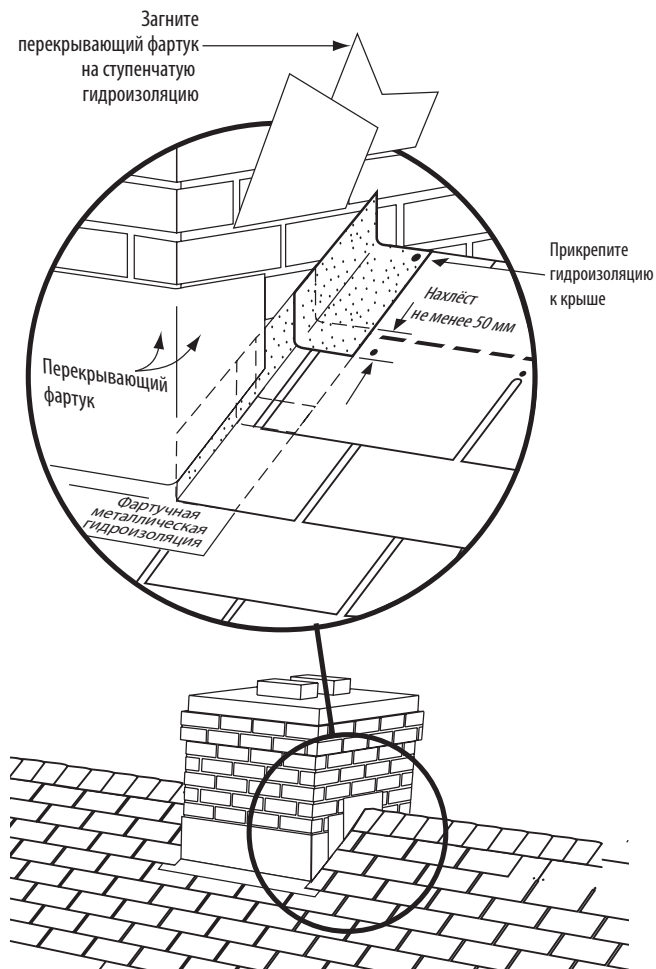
Металлическая гидроизоляция вокруг дымохода.
